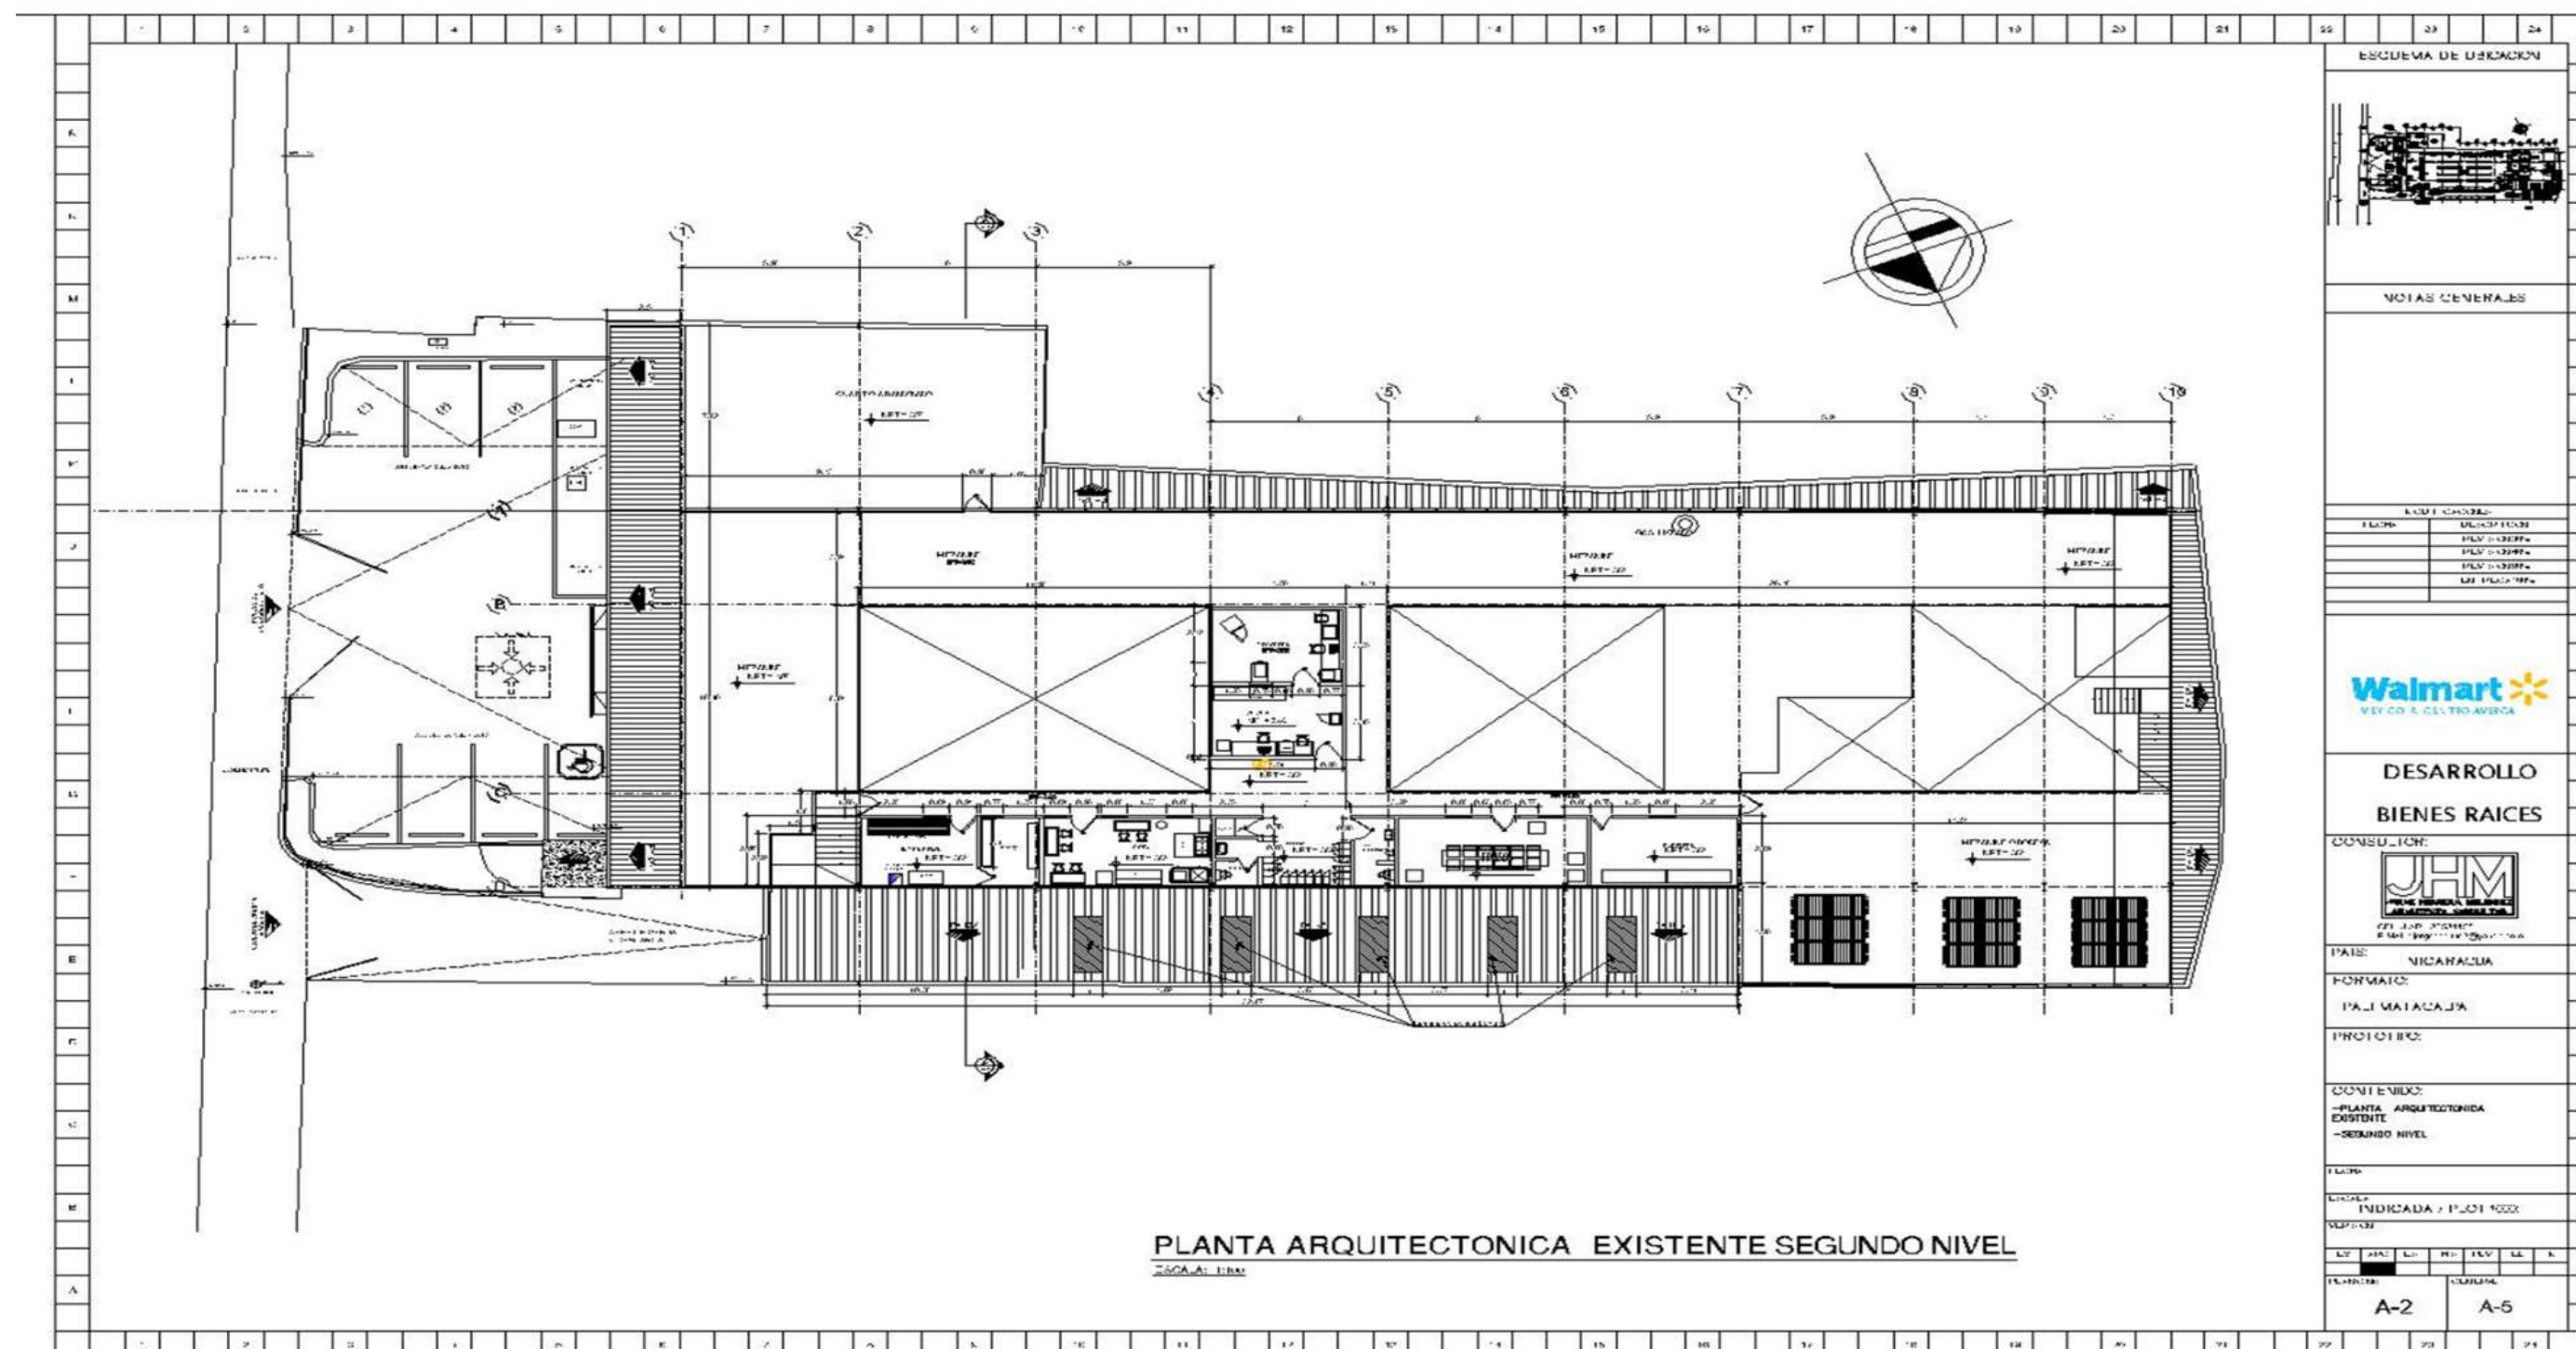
Plano del Segundo Nivel del Edificio. Fuente: Elaboración Propia.
